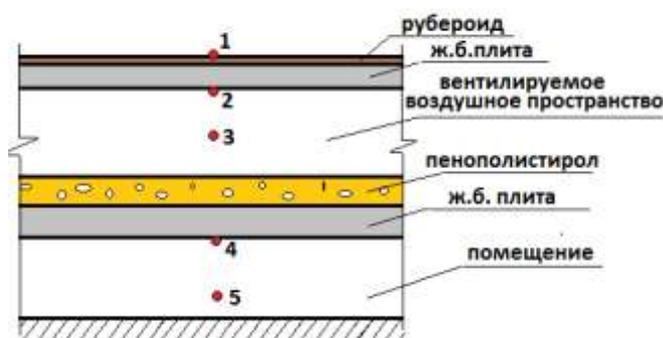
Точки установки термометров и термодатчиков (на примере эталонного макета) для измерения температуры: 1 – кровли; 2 – нижней поверхности кровельной панели; 3 – воздуха вентилируемого пространства; 4 – нижней поверхности панели перекрытия; 5 – воздуха помещения
